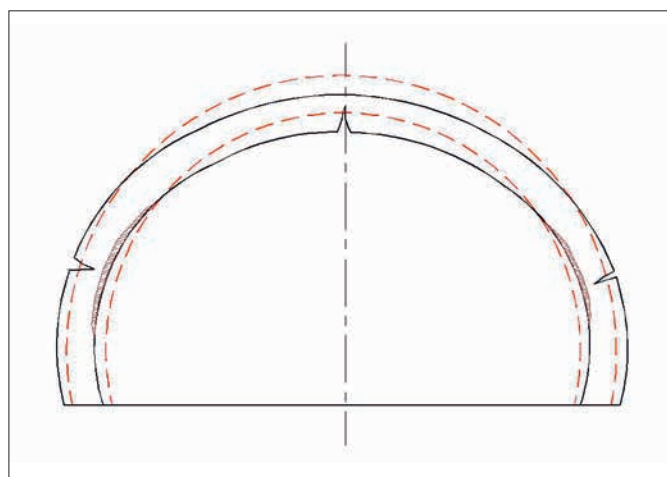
schéma simplifié des déformations du revêtement subissant un aplatissement (les zones hachurées indiquent les zones en compression, par rapport aux zones en extensions (fissures))
